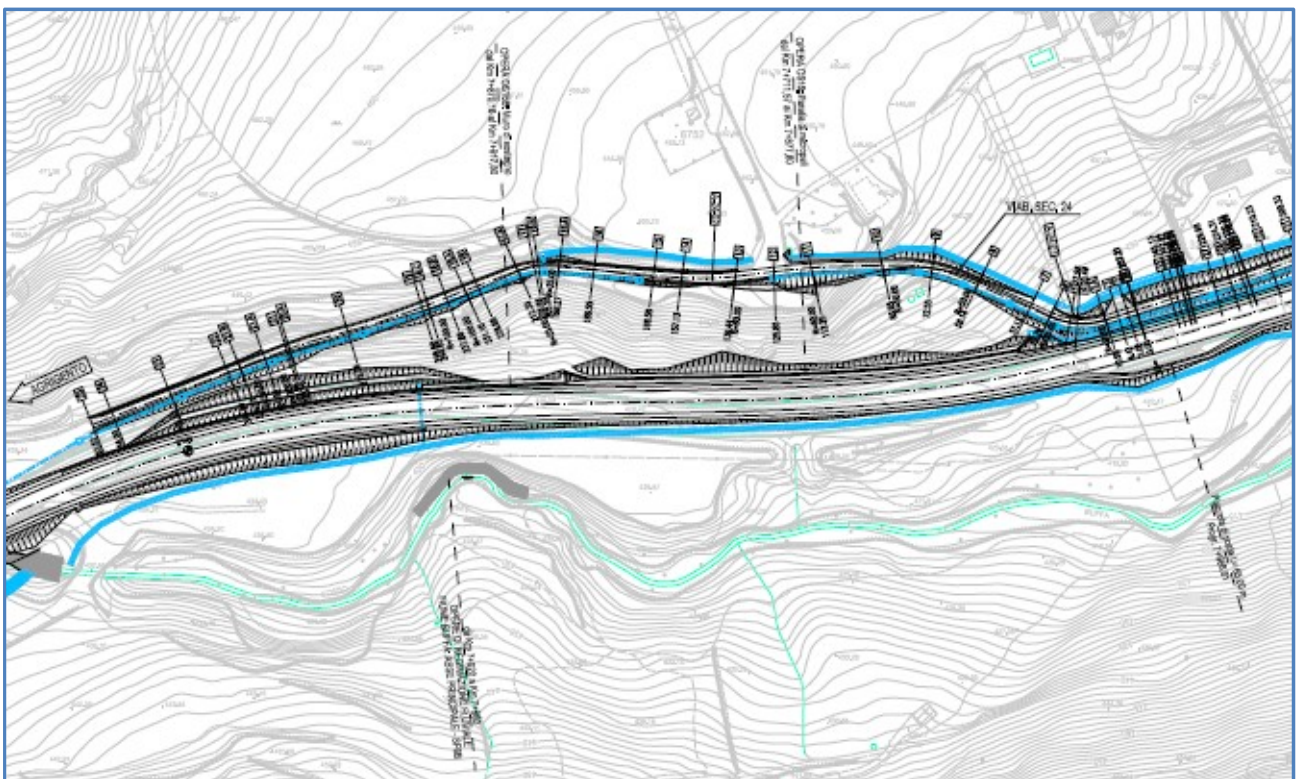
Stralcio planimetrico di M.T. 260 - Rif. codifica PEVS_P014_51_4137
